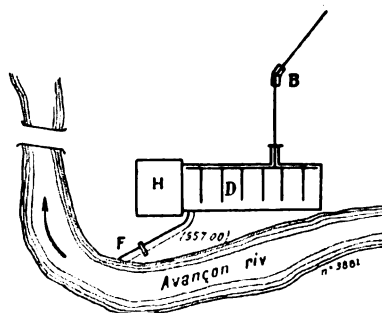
Plan des bâtiments de l'usine de Sublin.
